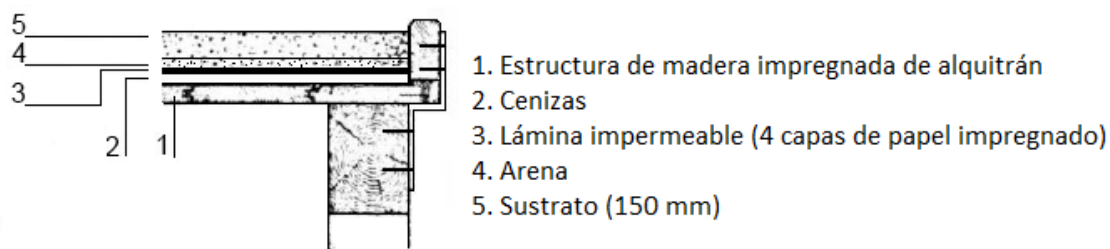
Detalle constructivo cubierta de Eduard Rüber.
